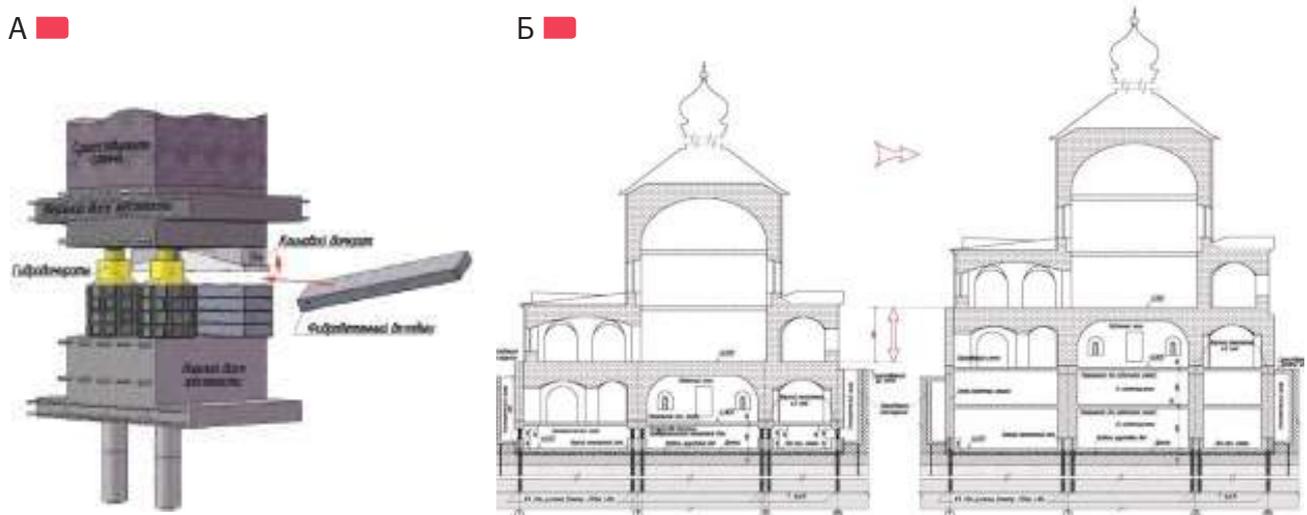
А – узел подъема здания с постепенно подкладываемыми элементами; Б – подъем на один этаж исторического здания церкви, проект «Реконфисс»
